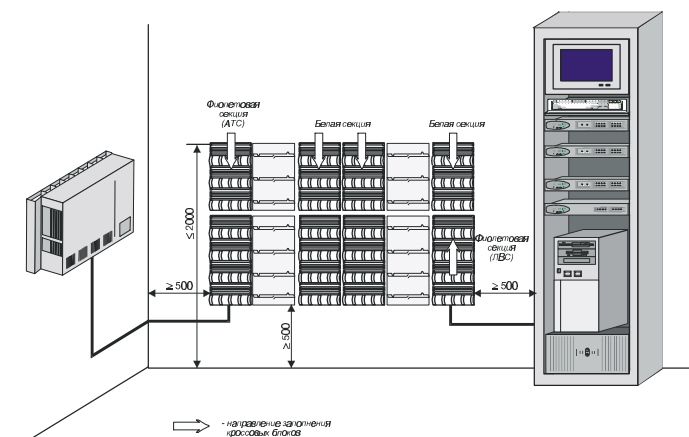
Пример плана размещения коммутационного оборудования 110 на стене помещения
